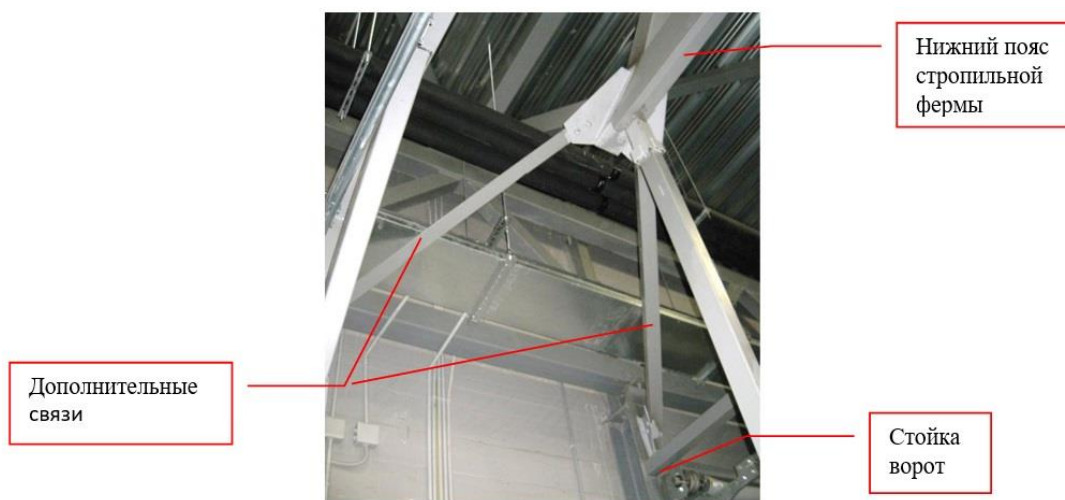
Прикрепление нижнего пояса стропильной фермы к стойке ворот и колонне каркаса по ряду А
